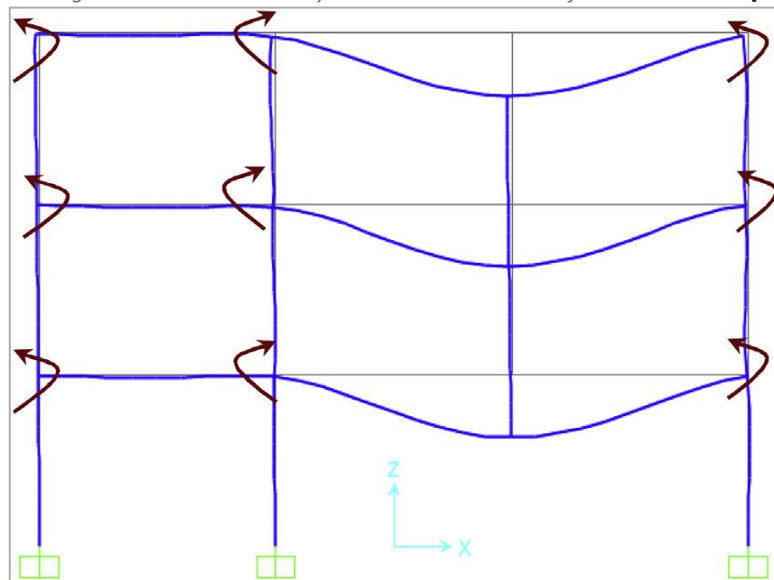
Acción de viga Vierendeel en pórticos donde se ha perdido una columna [14].
